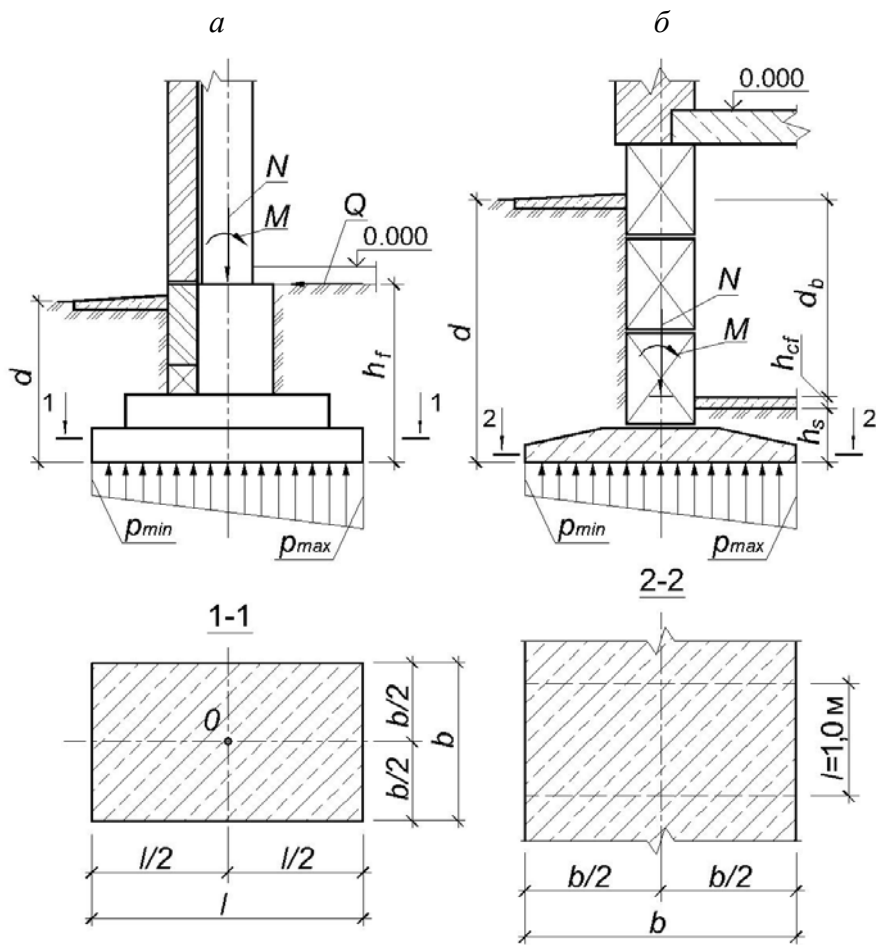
Расчетные схемы проектируемых фундаментов:
